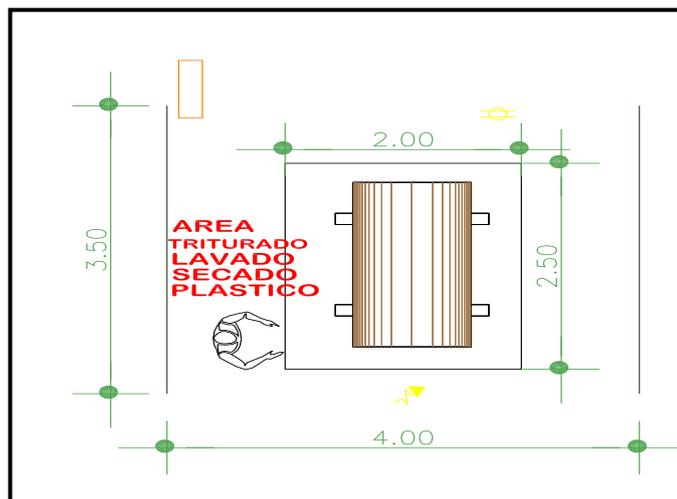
Vista arquitectónica específica del área de lavado y secado del plástico
